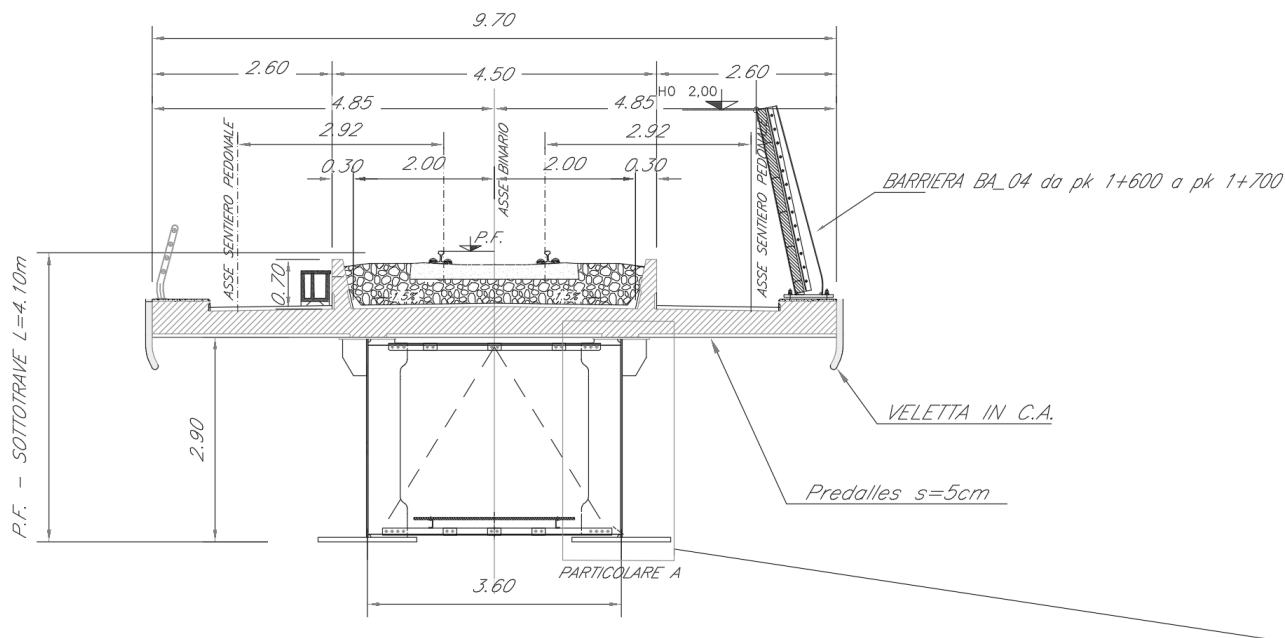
Sezione trasversale impalcato da 35m e 40m
